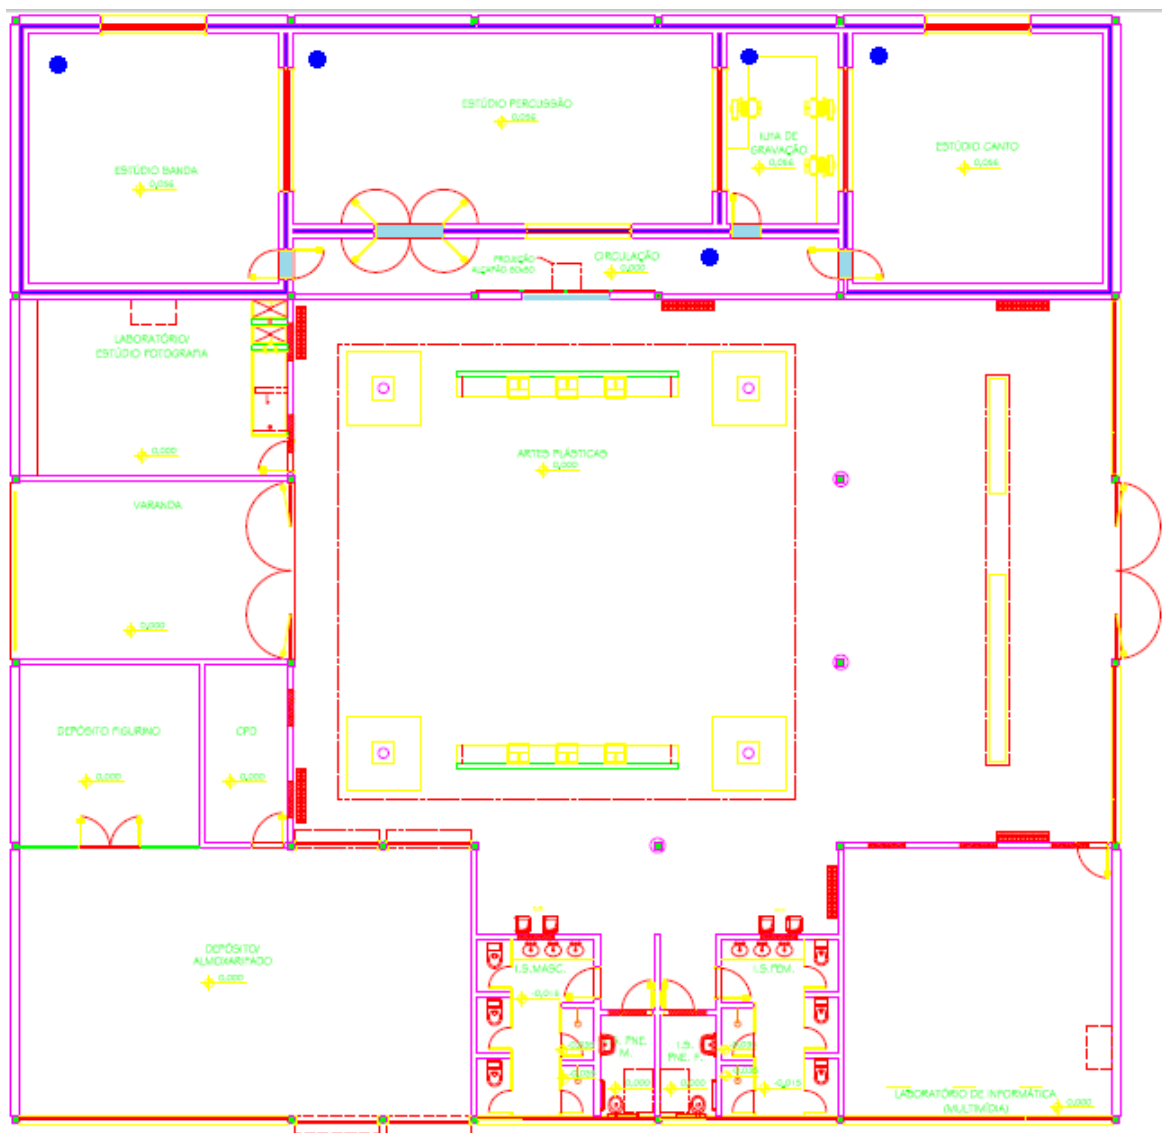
Planta de localização dos blocos Plug Minas (SENGEL CONSTRUÇÕES LTDA, 2012)
